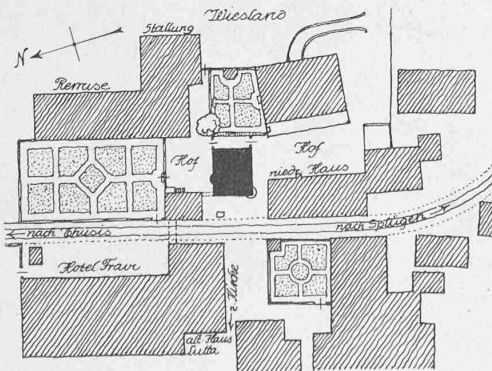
Lageplan zum Haus Fravi, Andeer. — Masstab 1:2000.
